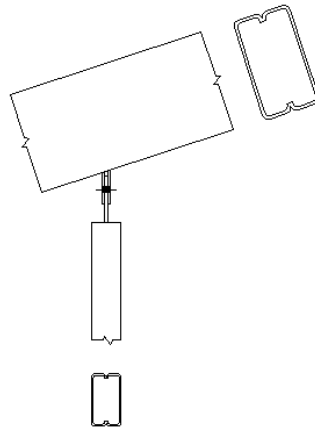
Esquema da ligação da coluna de fechamento frontal com a viga
